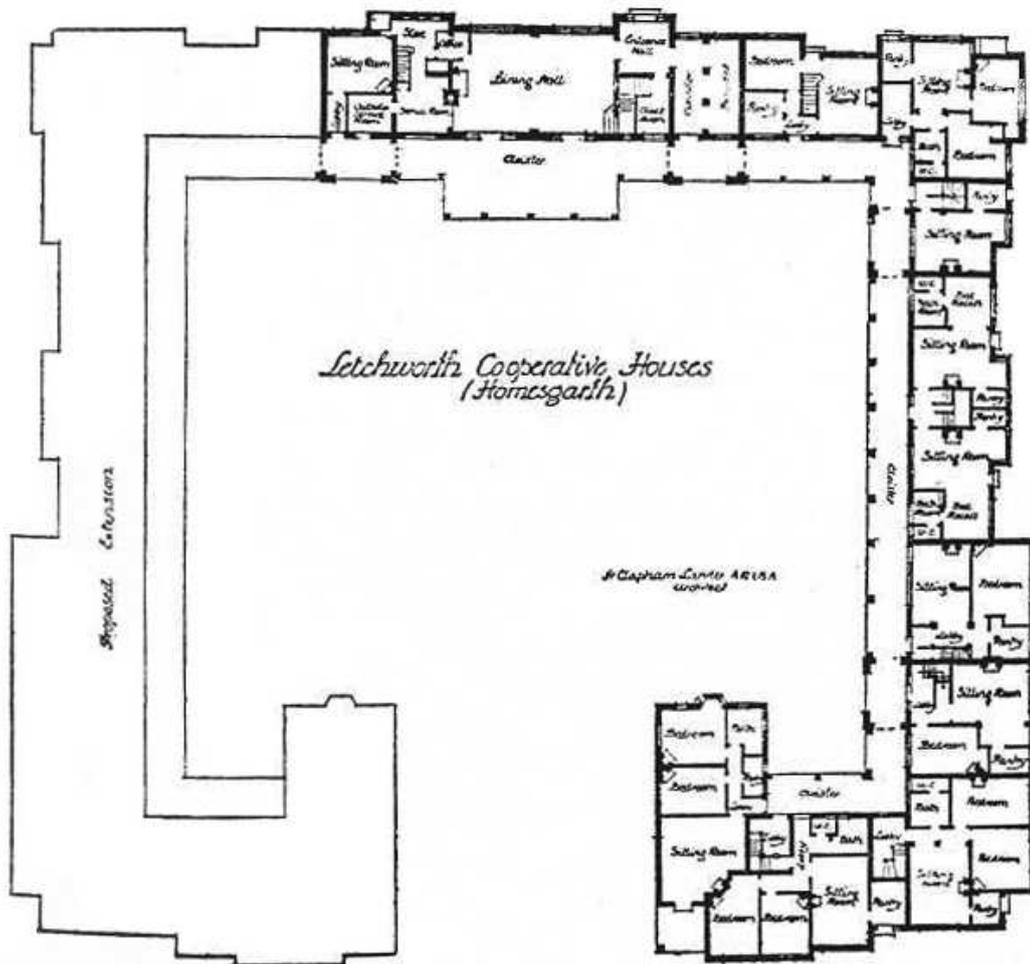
Einküchenhausanlage Homesgarth in Letchworth Garden City, 1903, Architekt C. Lander, *Collective Housekeeping als Grundprinzip der neuen Stadt
